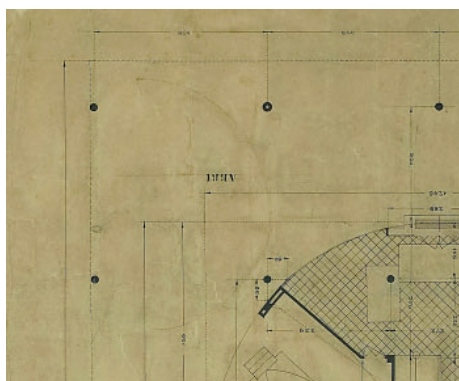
Plano de la planta baja de la Villa Savoye a escala 1:50, Atelier LC-PJ, 12-4-1929. FLC 19439 (pormenor).
